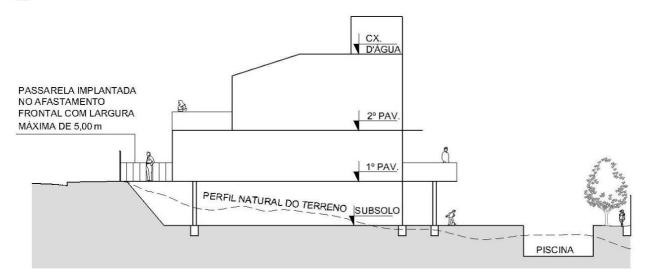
Elemento construtivo no afastamento frontal no terreno em declive: passarela
